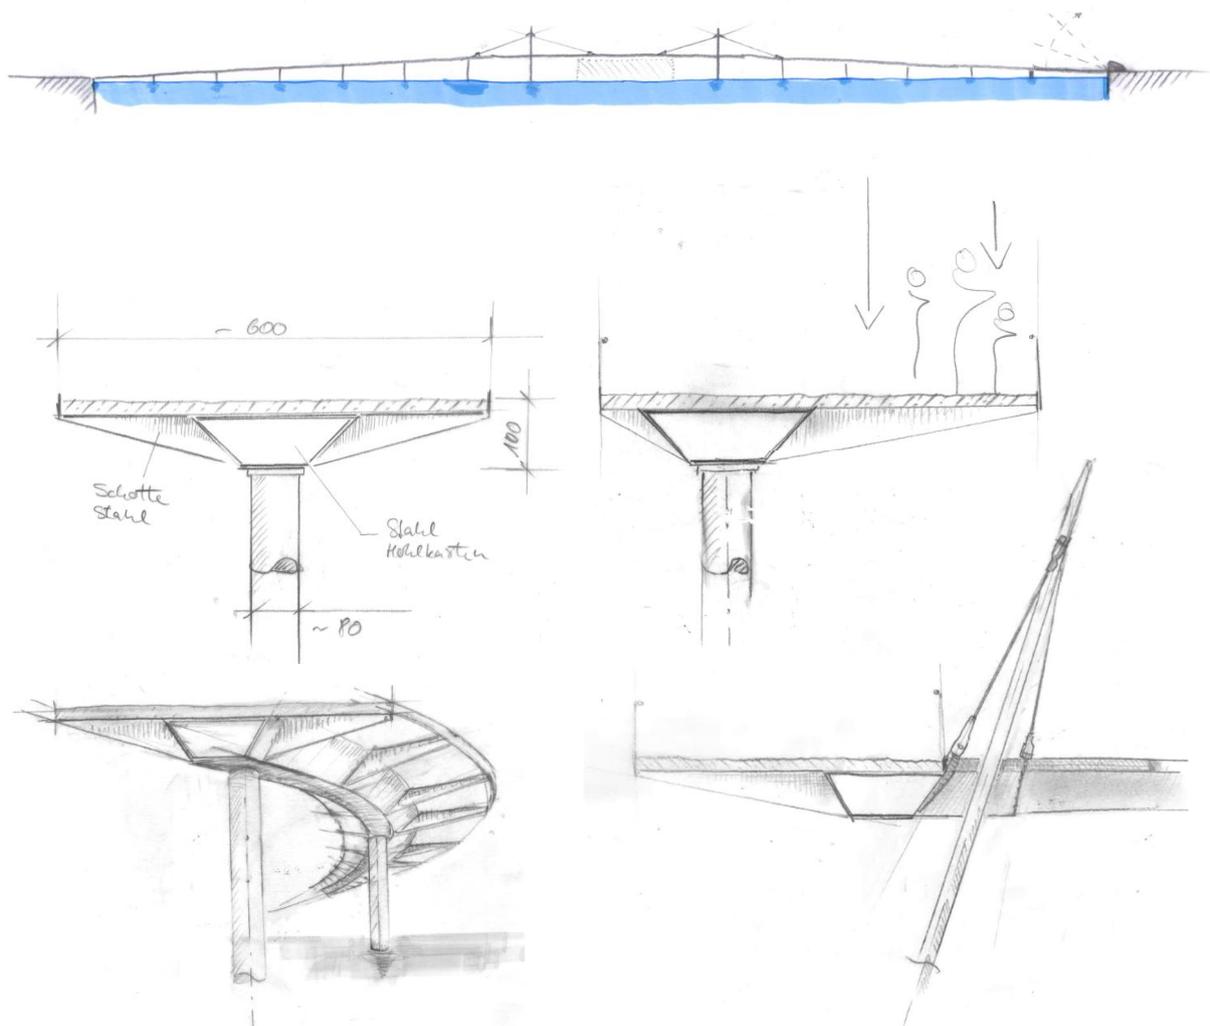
Entwurf und Konstruktion der Vorzugsvariante
